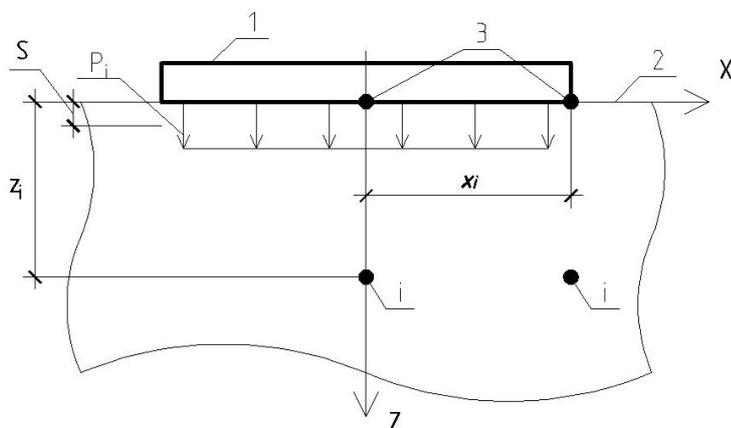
Схема расположения локальных повреждений грунтового основания: 1 – фундамент; 2 – грунтовое основание; 3 – локальное повреждение; Z_i , X_i – координаты положения локального повреждения
